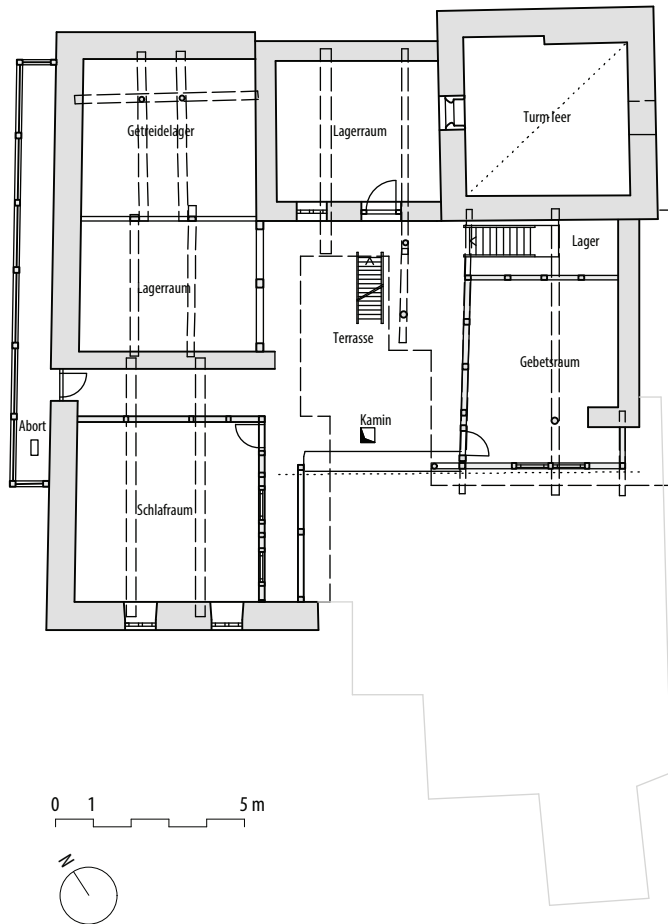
Grundriss zweites Obergeschoss. Turmhaus in Zhongglu bei Danba.
